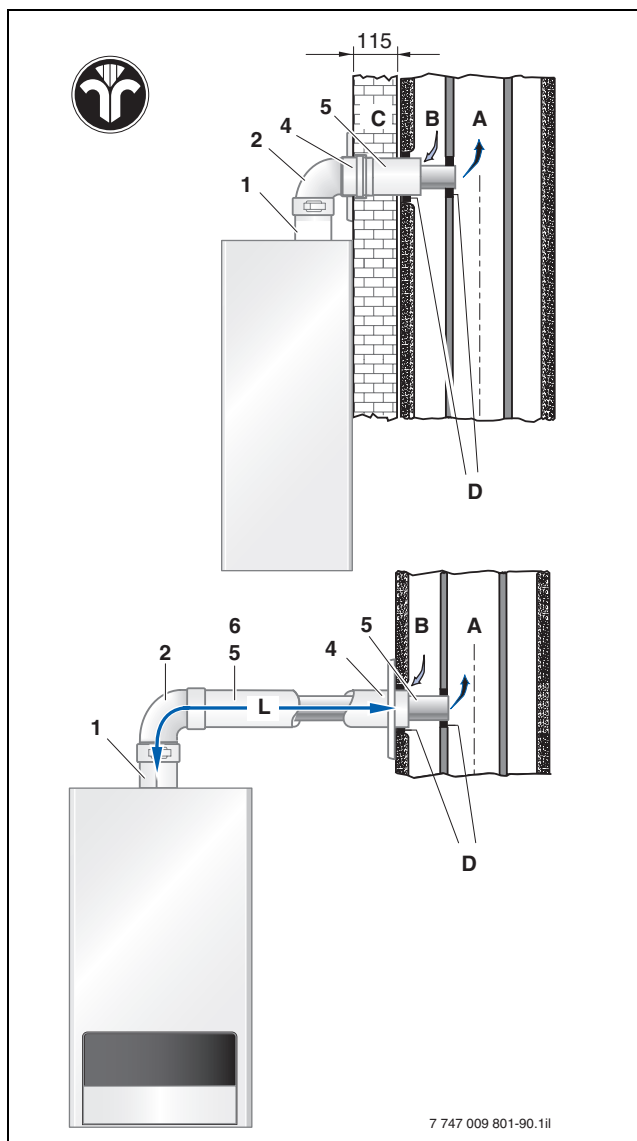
Montagevariante mit dem Bausatz LAS-K für U152 (Maße in mm); maximal zulässige gestreckte Baulänge L der Abgasleitung → Tabelle 39, Bauteile → Seite 99
